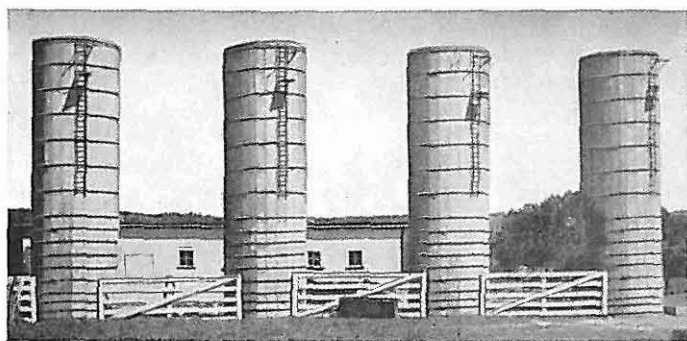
Futtersilos aus Betondauben (Betonplatten)
